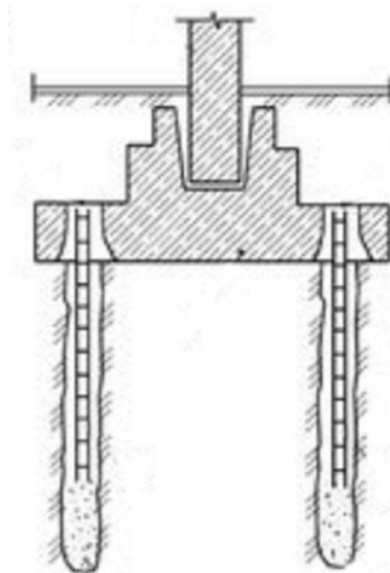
Повышение несущей способности фундаментов путем передачи части нагрузки от колонны здания на сваи [1]
